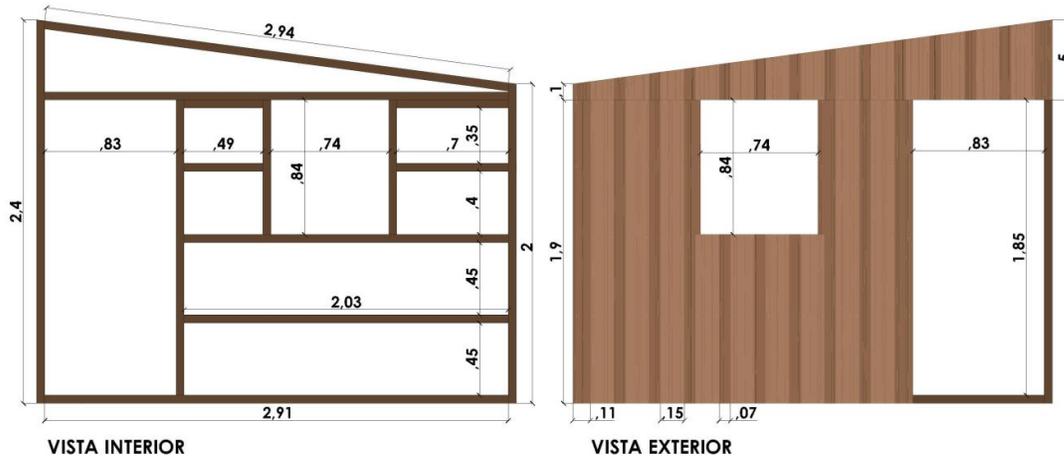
Plano panel delantero puerta de la vivienda de emergencia de Un Techo Para Mi País
